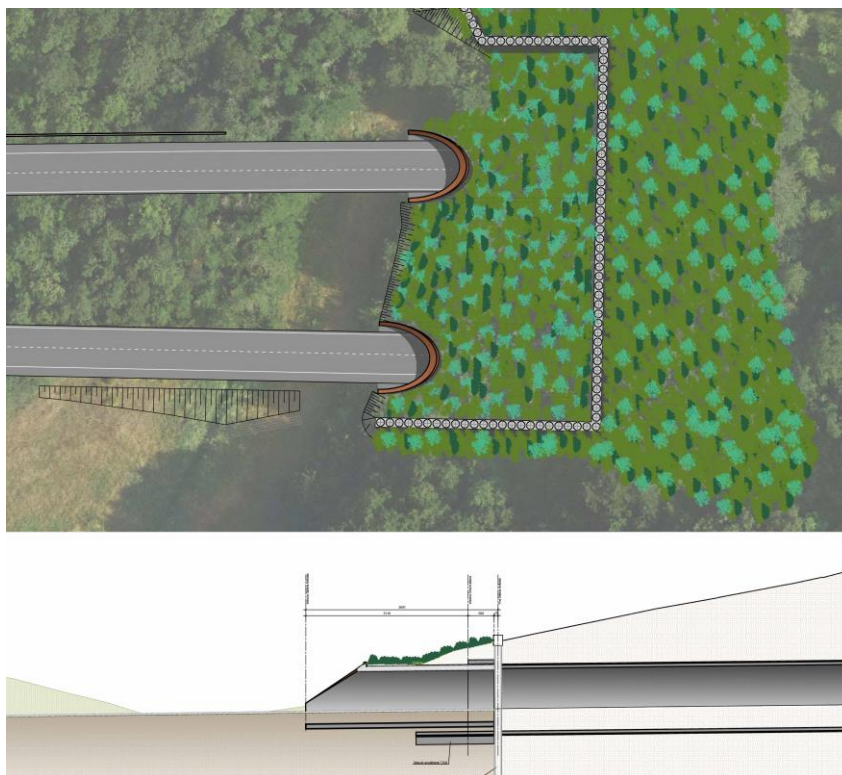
Planimetria e prospetto galleria Citerna (imbocco ovest)
